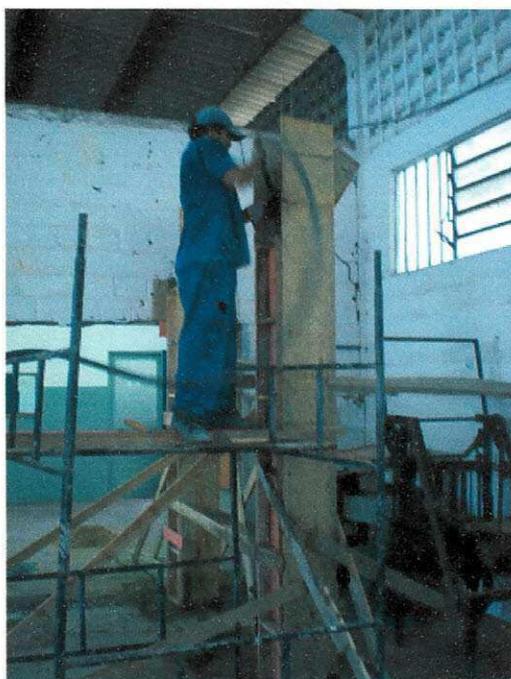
Lançamento do concreto e adensamento com vibrador.
